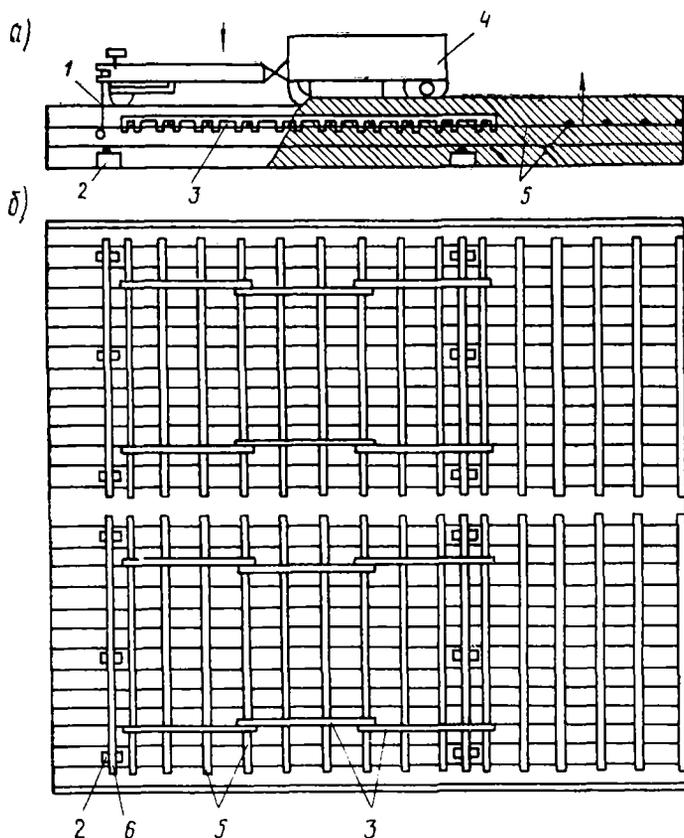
Схема раскладки арматурных стержней и установки переносных гребенок при устройстве покрытия бетоноукладчиком типа Д-181А:
